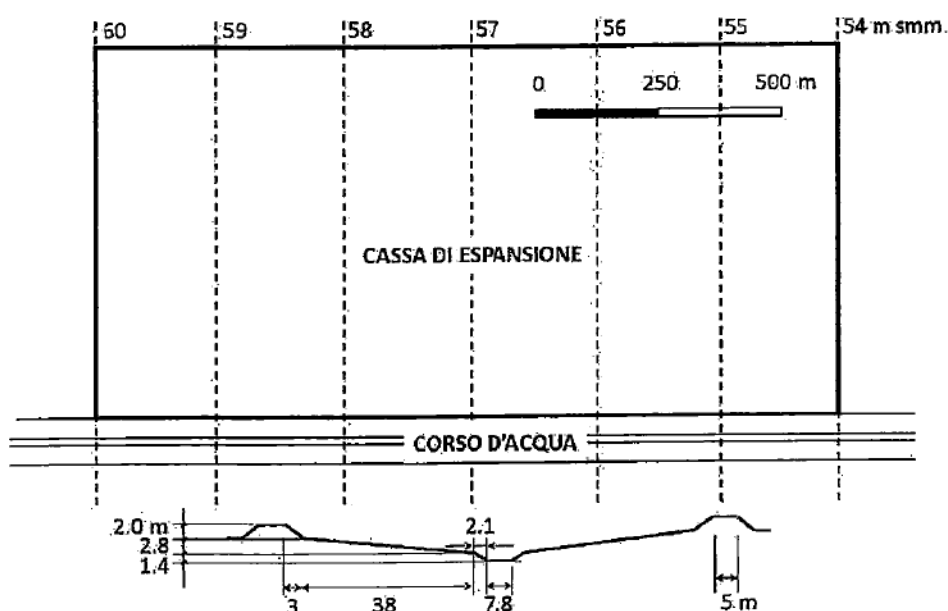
schema planimetrico con l'indicazione dell'area della cassa, le quote del terreno in m s.m.m. e la sezione tipo del corso d'acqua
